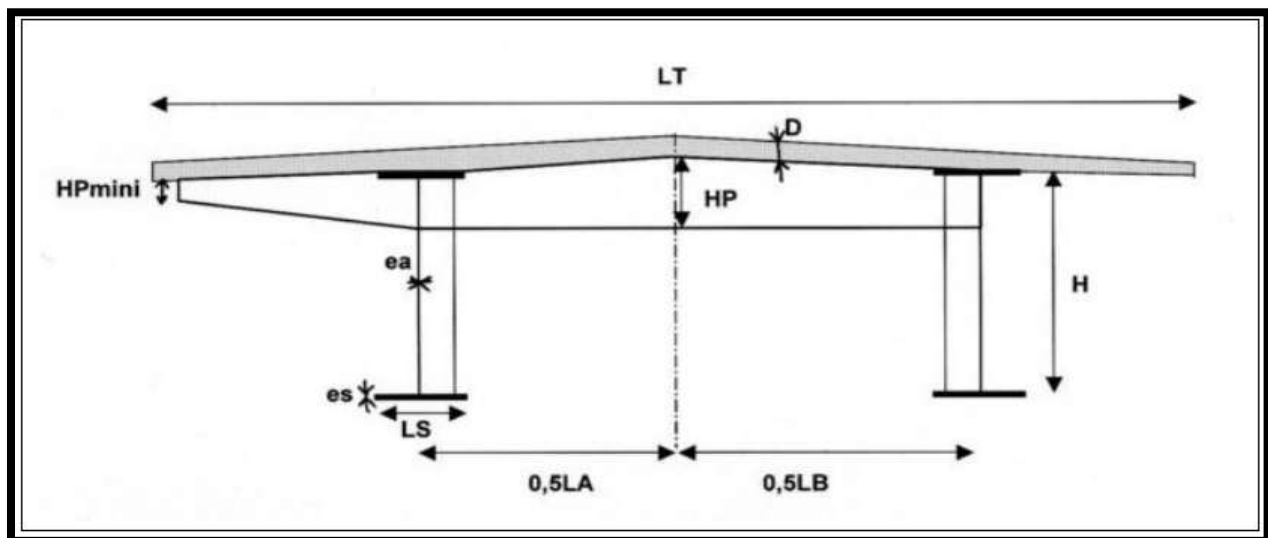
Paramètres du dimensionnement d'un bipoutre à pièces de pont
